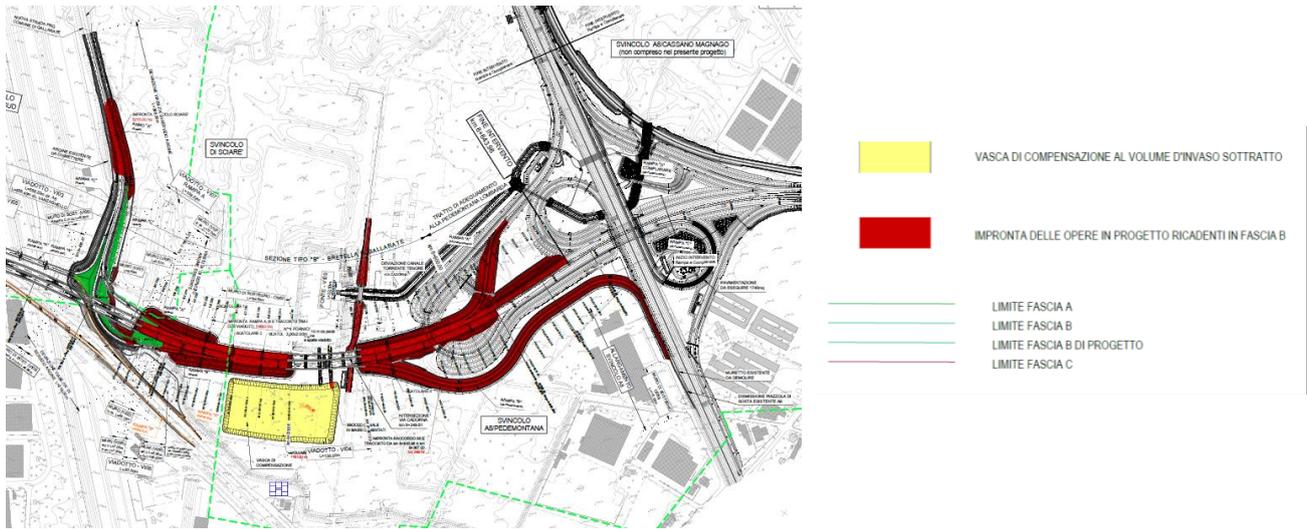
PLANIMETRIA DI DETTAGLIO FASCE FLUVIALI RILE E TENORE
